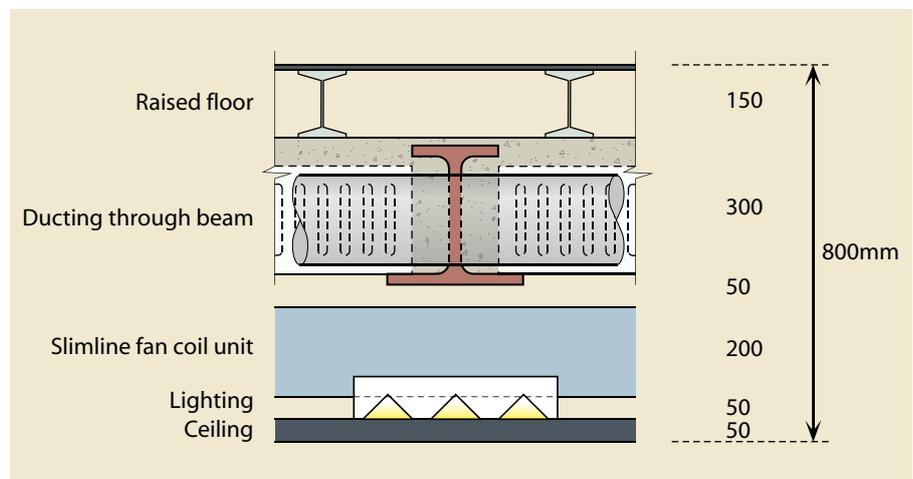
Típica sección transversal de Slimdek con el sistema de aire acondicionado integrado en el forjado
